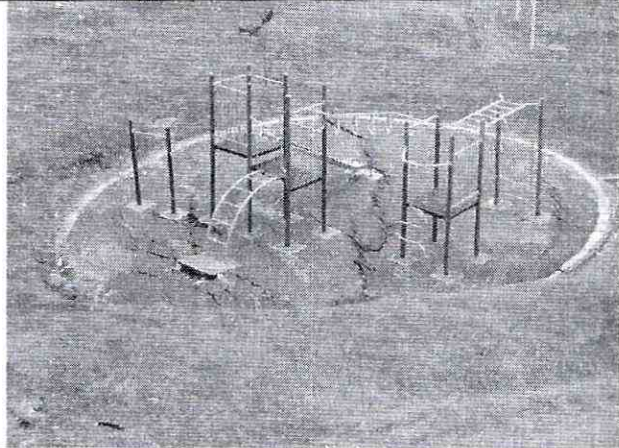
Patio de Juegos infantiles localizado hacia la parte central del parque, con claras deformaciones y agrietamientos observados en el piso en concreto flexible..
